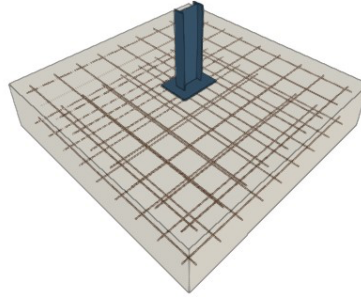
Zapata tipo 1. CYPE Ingenieros.
